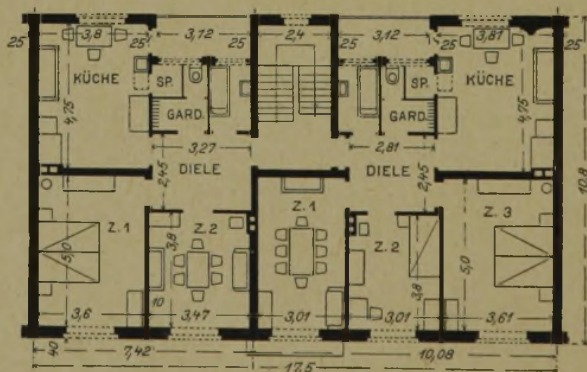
Typischer Wohnungsgrundriß für Küche, 3 Zimmer, Bad mit 74,5 qm; Küche, 2 Zimmer, Bad mit 64,5 qm Grundfläche.
